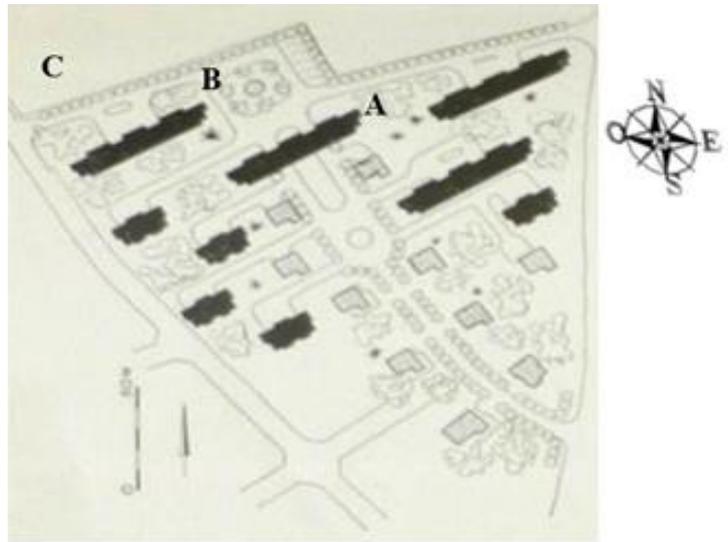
Localisation des barres sur le plan du lotissement du quartier Saint-Exupéry par le commissariat à la Reconstruction et au logement. *Source : AA, 1955, p. 92.
